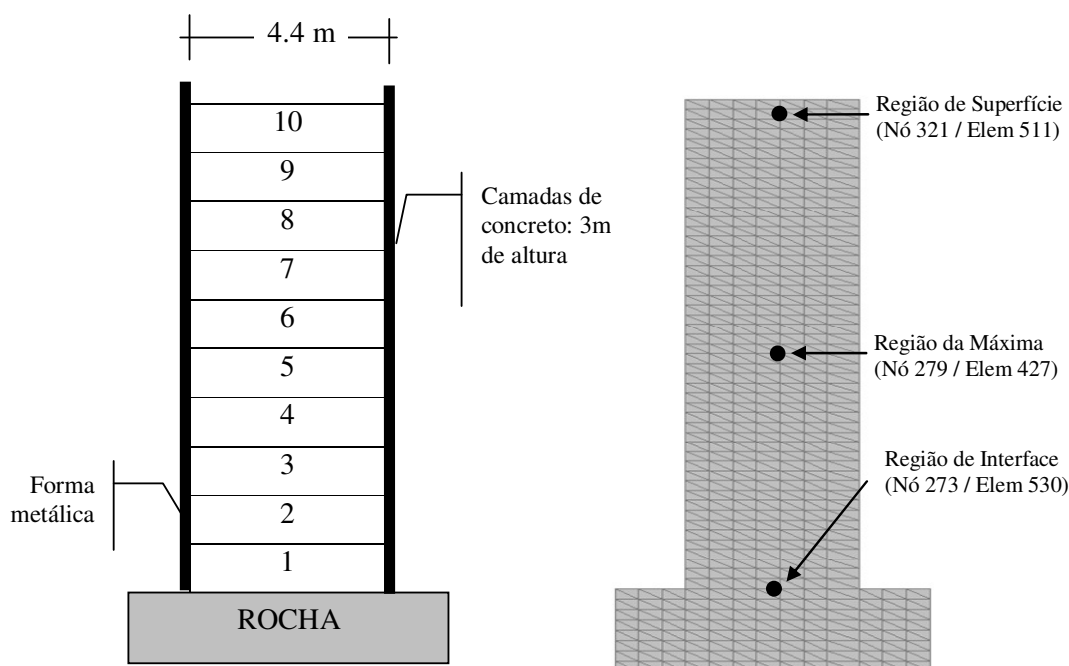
Seção transversal e malha de elementos finitos da estrutura de concreto analisada.
